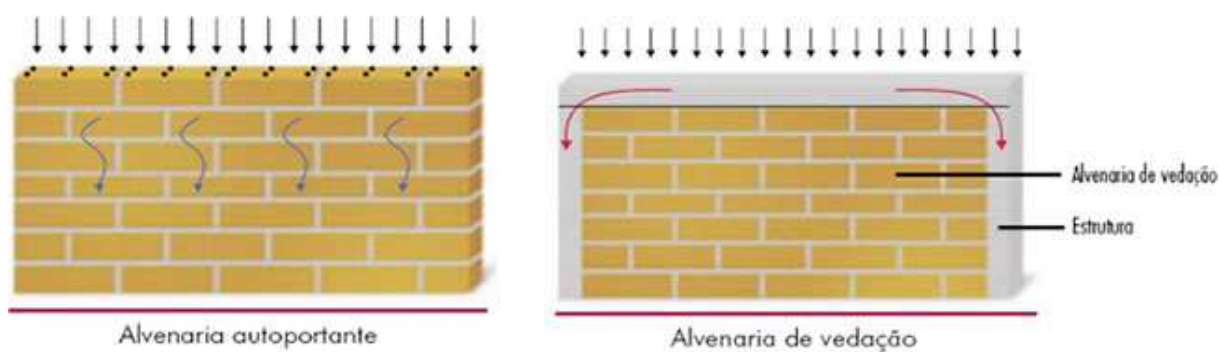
Paredes de vedação. As vigas e pilares transferem as tensões às fundações
